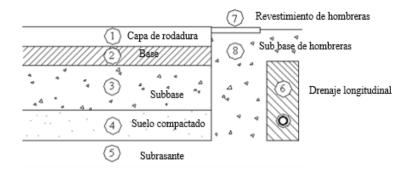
Sección típica de un pavimento flexible (UMSS, 2021)
